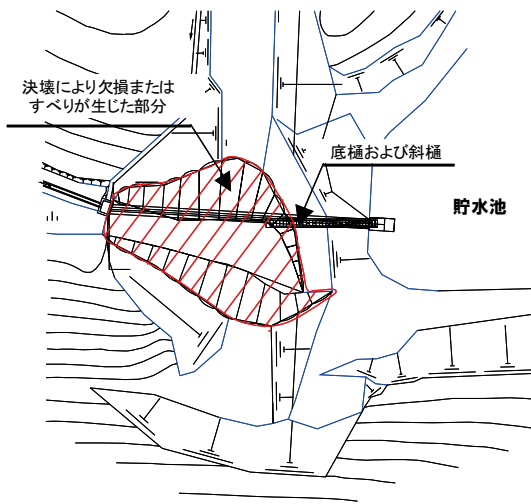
平成22年4月13日に決壊したため池堤体の平面図
